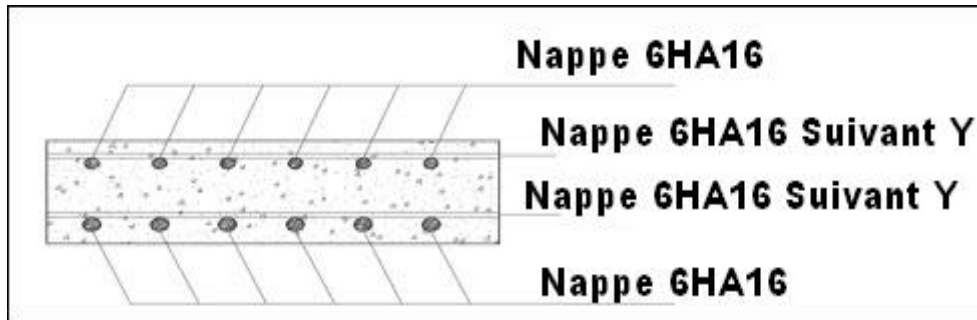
Ferrailage de la dalle dans le sens X.
